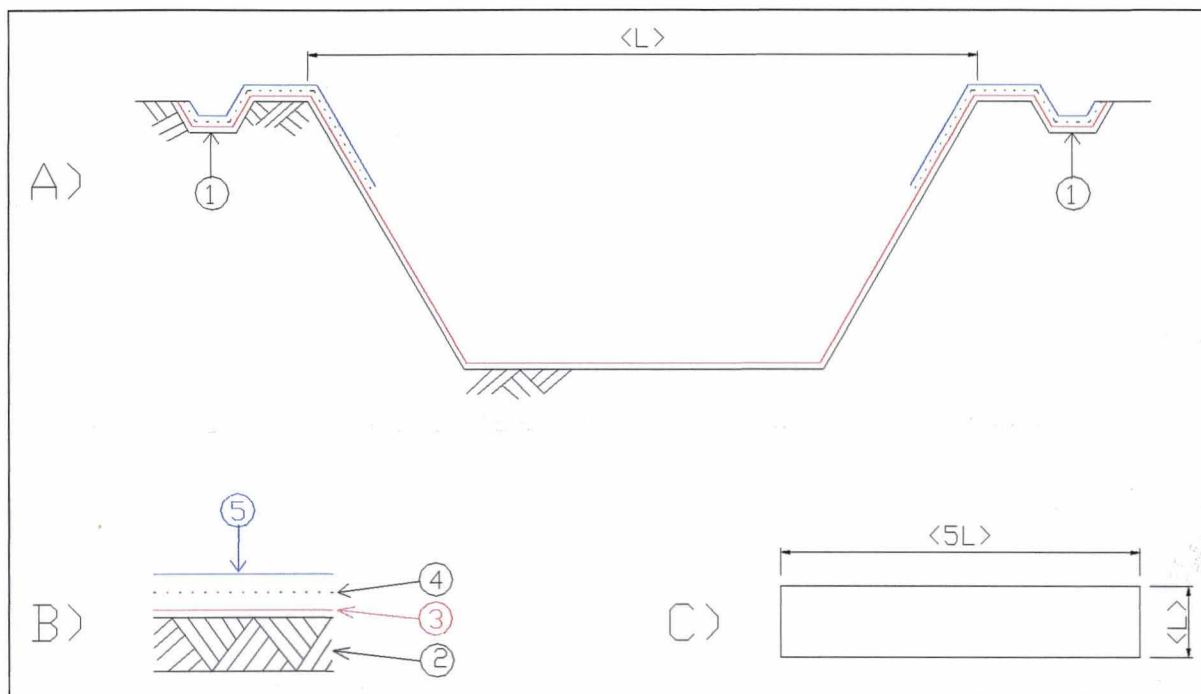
Proposta de construção e revestimento de esterqueira para dejetos líquidos, onde: A) corte esterqueira mostrando drenos laterais (1) e revestimento; B) detalhamento do revestimento, sendo 2 – solo natural compacto, 3 – lona em PVC flexível, 4 – tela de PVC rígido e 5 – argamassa de cimento e areia; C) disposição largura (L) x comprimento (5L)
